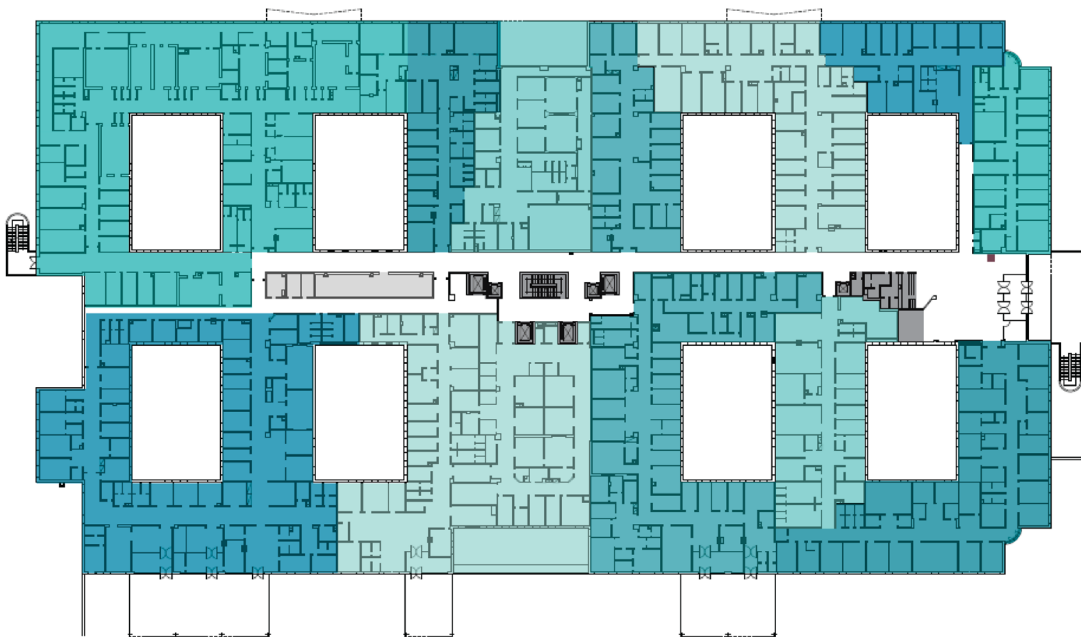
Planta arquitectónica do piso 1 do Hospital Pêro da Covilhã (Fonte: Ana Malta)
